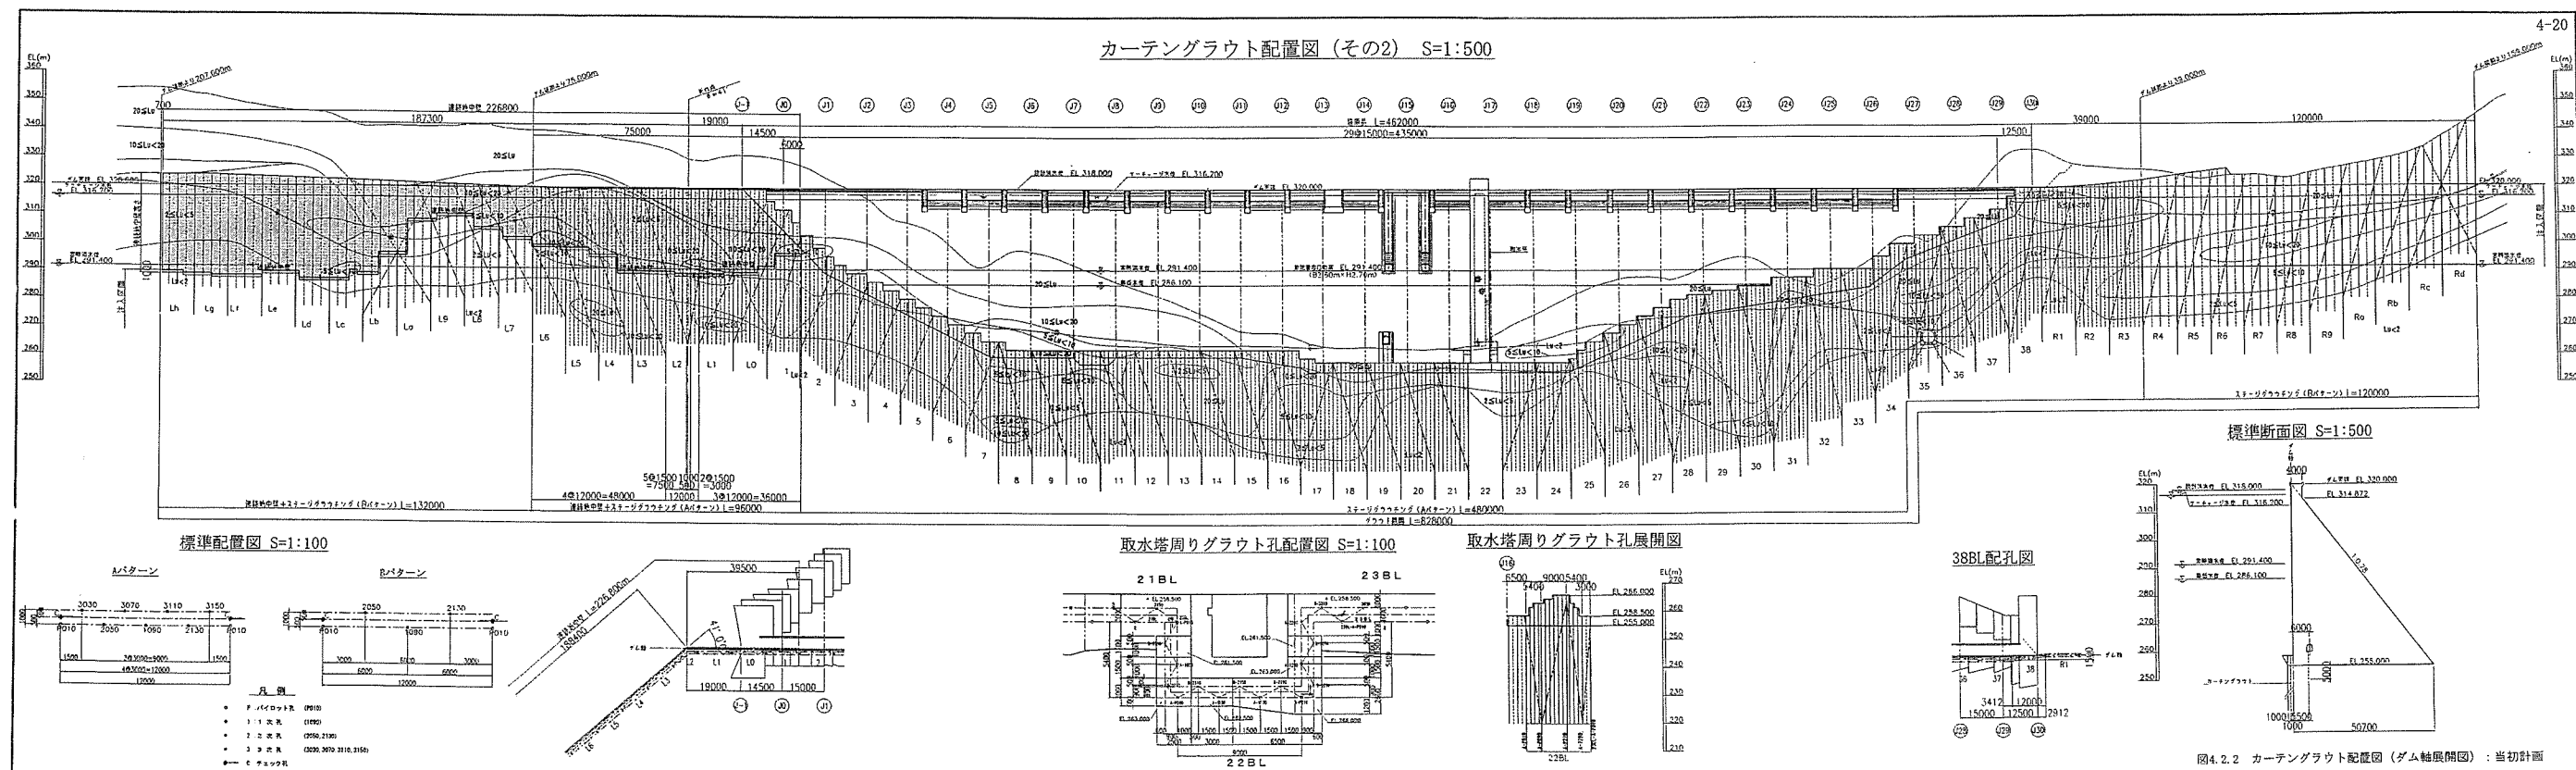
カーテングラウト配置図 (ダム軸展開図) : 当初計画
